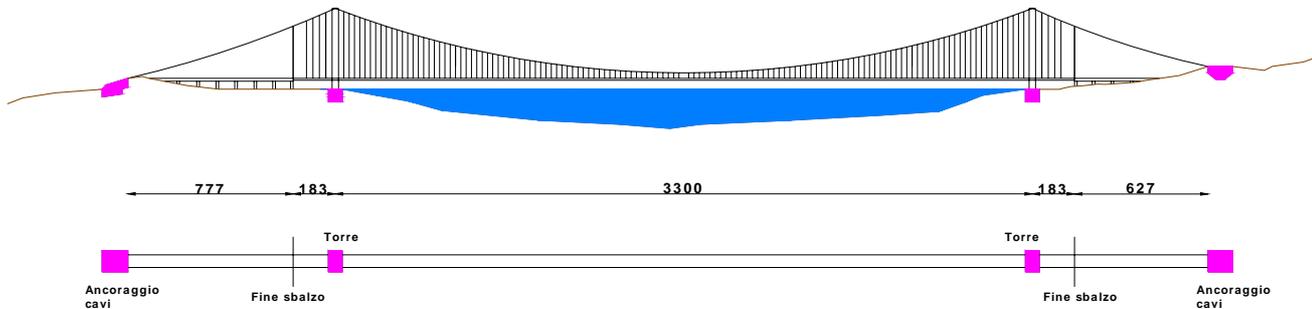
sezione longitudinale e schema planimetrico dell'impalcato
